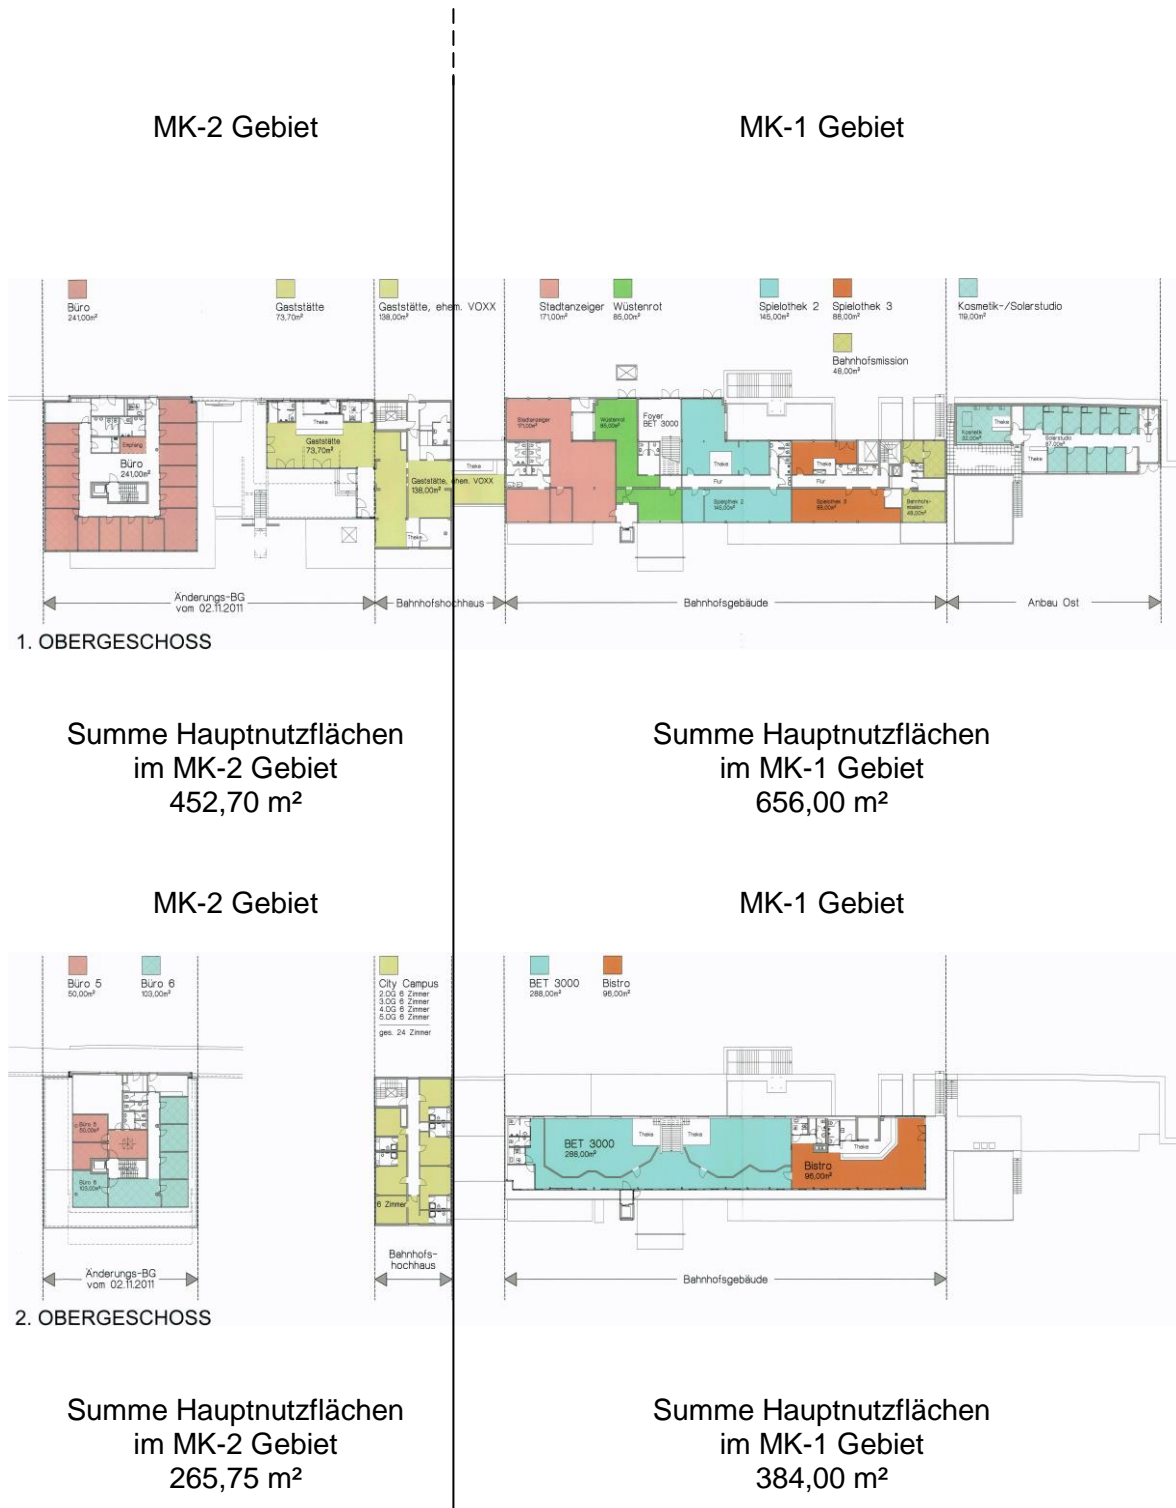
Grundrisse (Stand 28.02.2012)
